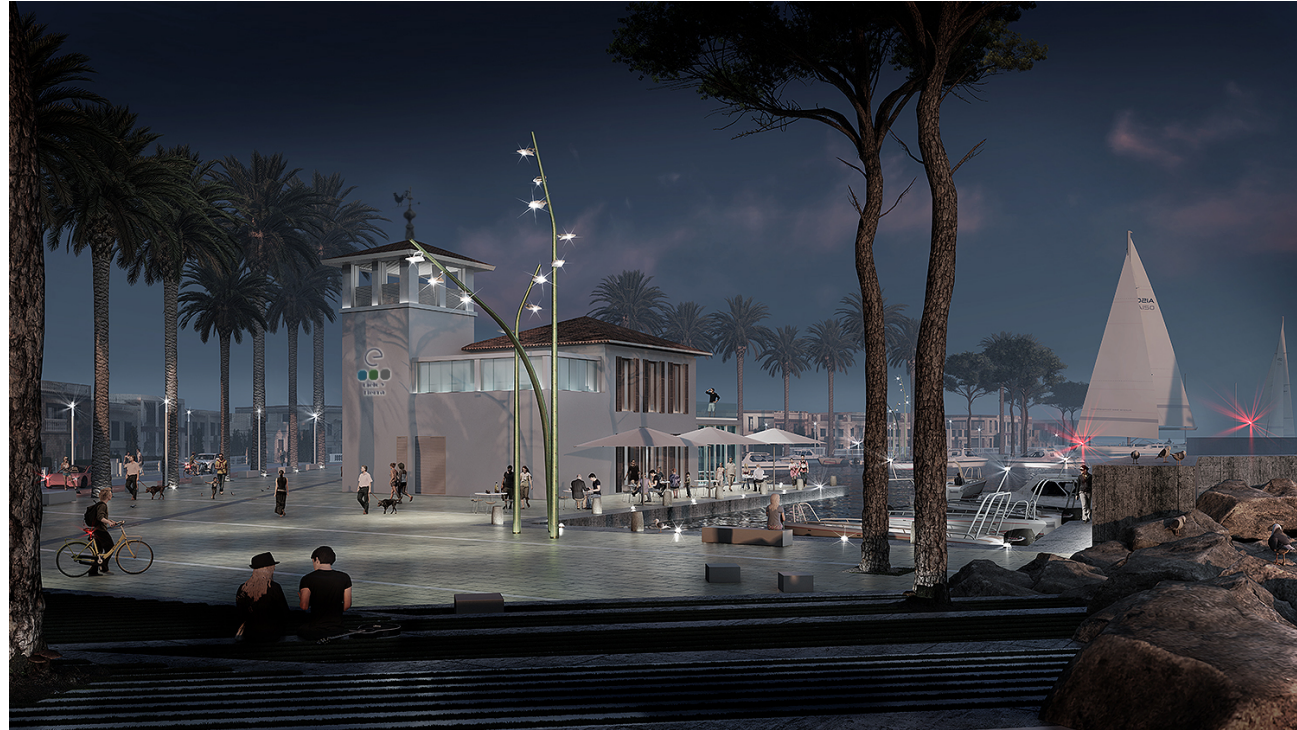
Infografía de la propuesta. Fachadas Oeste y Sur.
